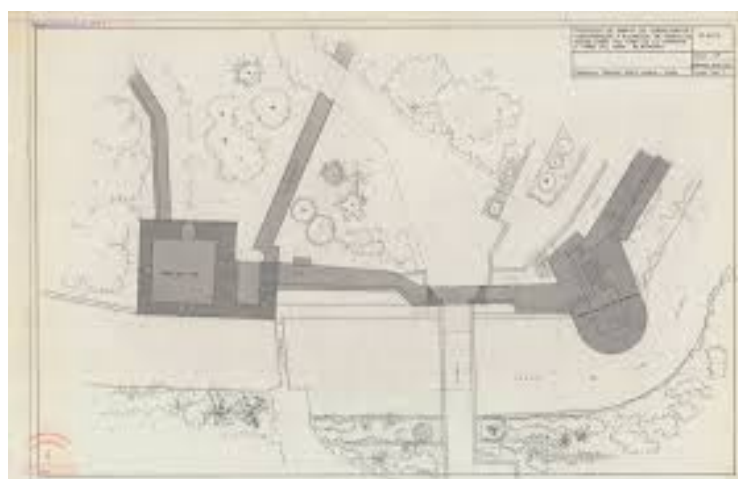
Torre del Cabo de la Carrera. Plano del proyecto de obras de consolidación de Prieto-Moreno
